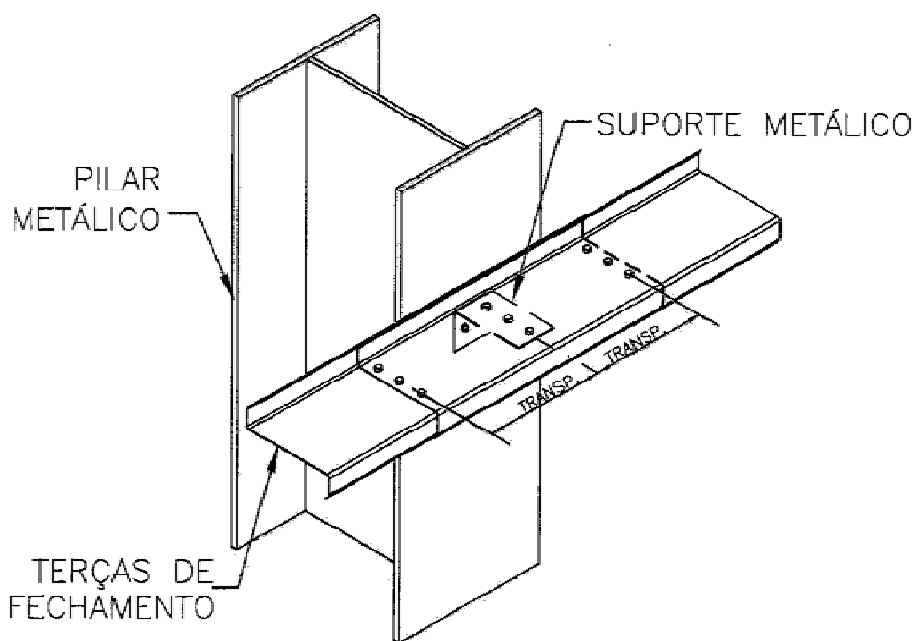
Fixação das terças em pilares metálicos (Fonte: catálogo Medabil)
